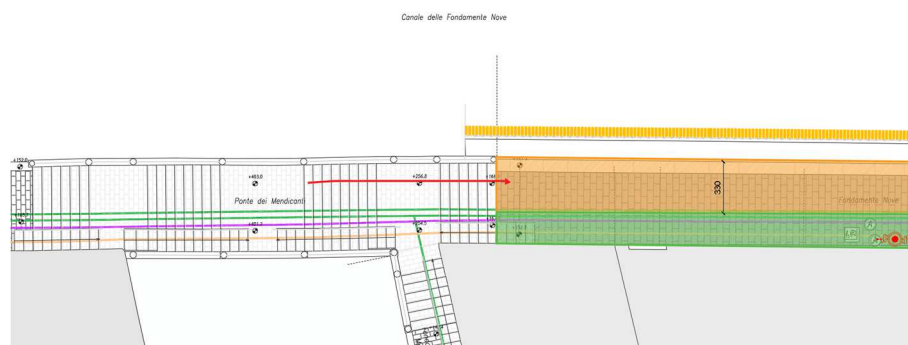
ORGANIZZAZIONE CANTIERE – FASE 2 (SU SINGOLO LOTTO)
